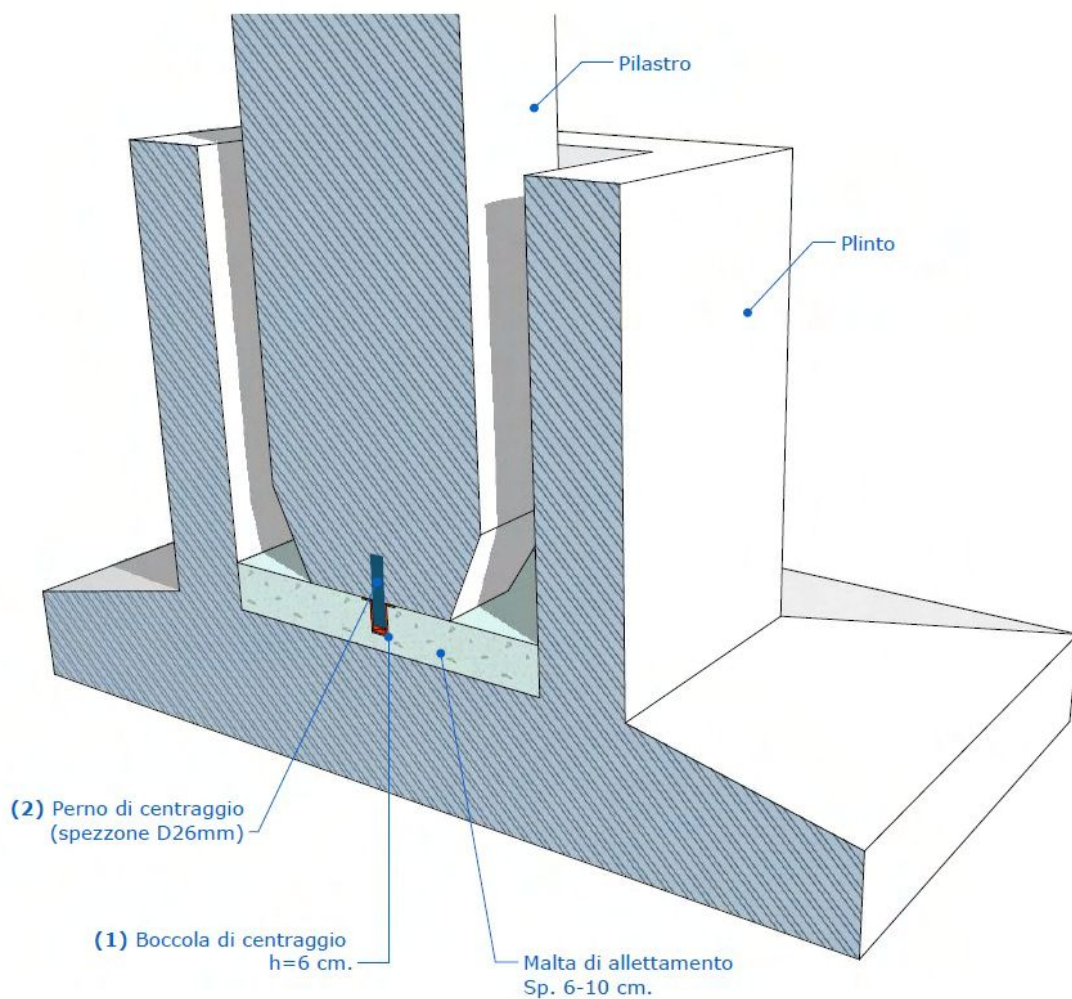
Fondazione prefabbricata. Fonte impresa "Tre Colli".
